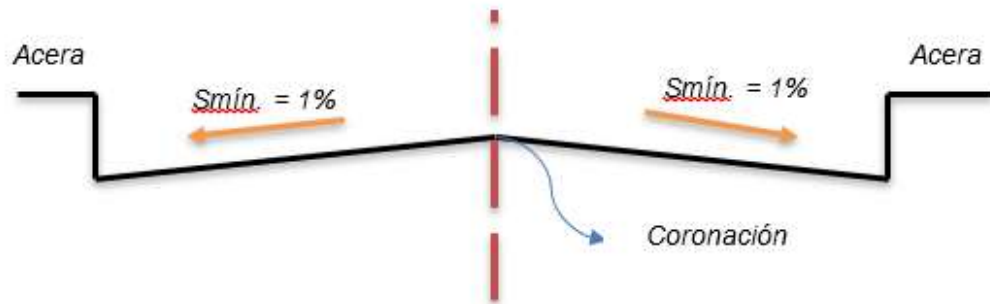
Sección Recomendable para calle con ancho menor a 8 m.
